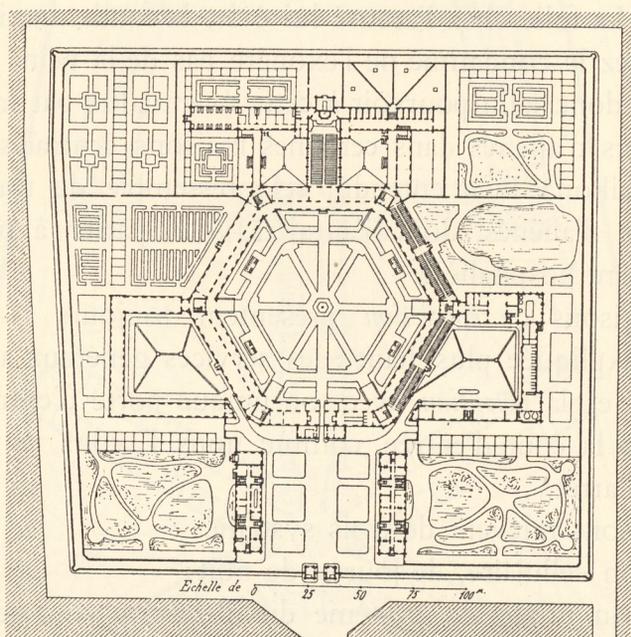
Maison centrale de Rennes. Plan du rez-de-chaussée.
